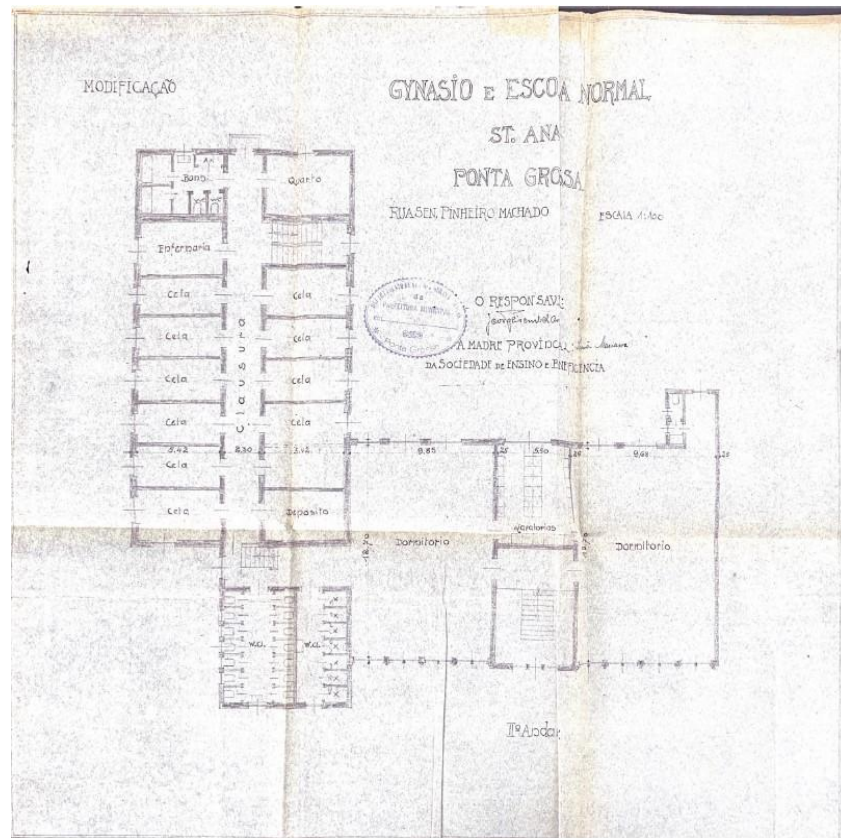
Planta executada do segundo pavimento. Fonte: Casa da Memória, 2022.
